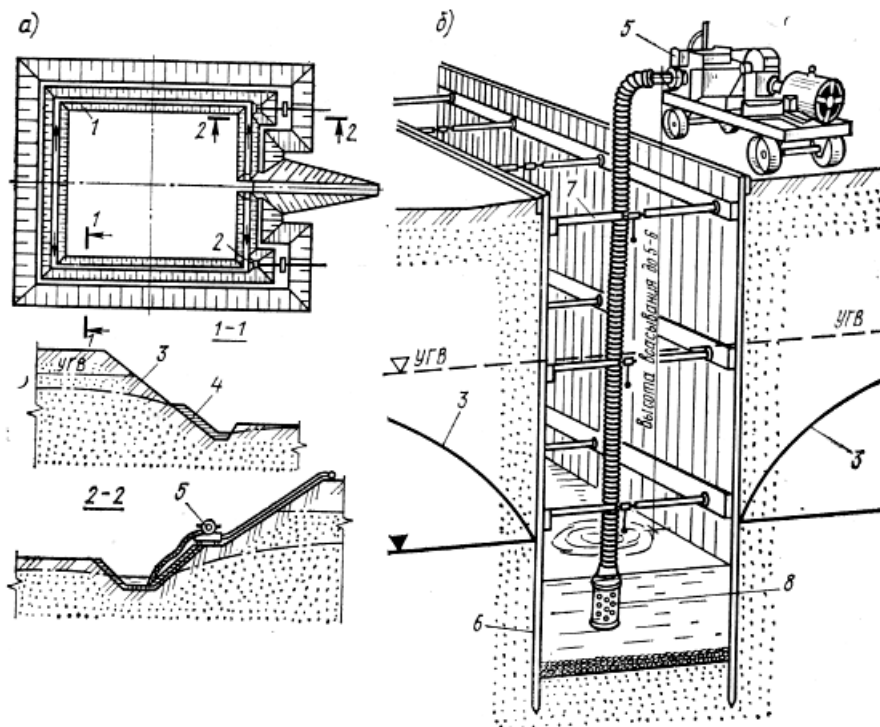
Открытый водоотлив из котлована (а) и траншеи (б): 1 – дренажная канава; 2 – приямок (зумпф); 3 – пониженный УГВ; 4 – дренажная пригрузка; 5 – насос; 6 – шпунтовое крепление; 7 – инвентарные распорки; 8 – всасывающий рукав с сеткой (фильтром)
